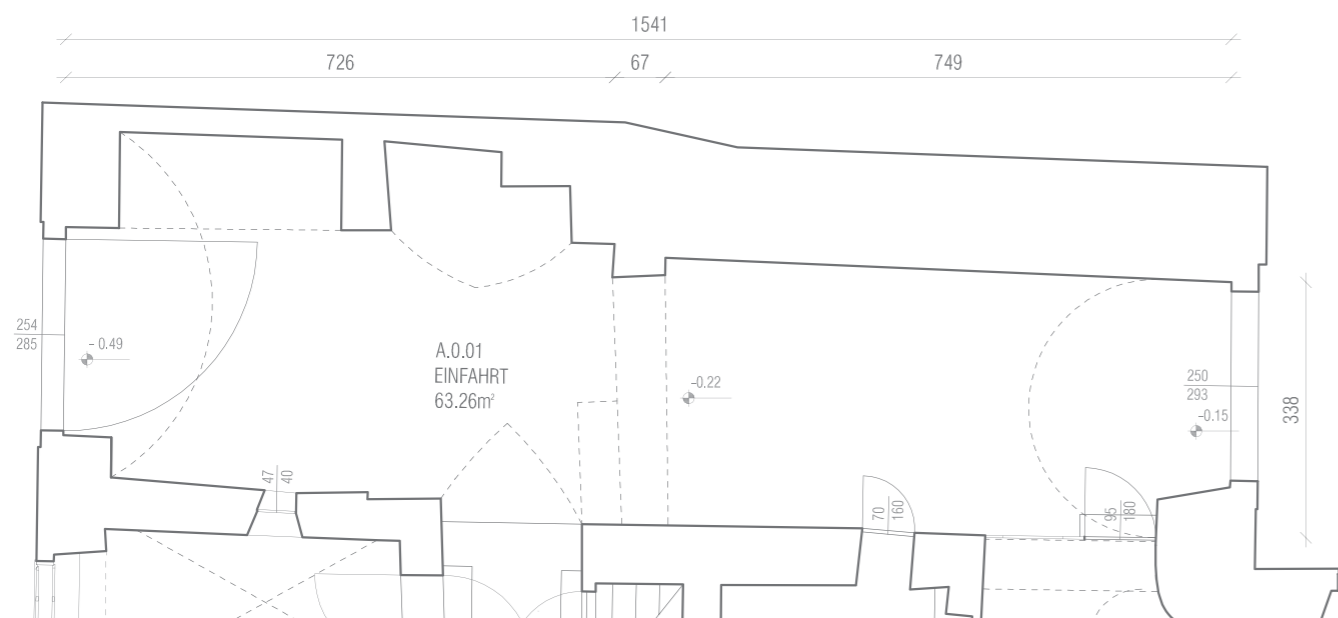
Grundriss Raum A.0.01_1:100
